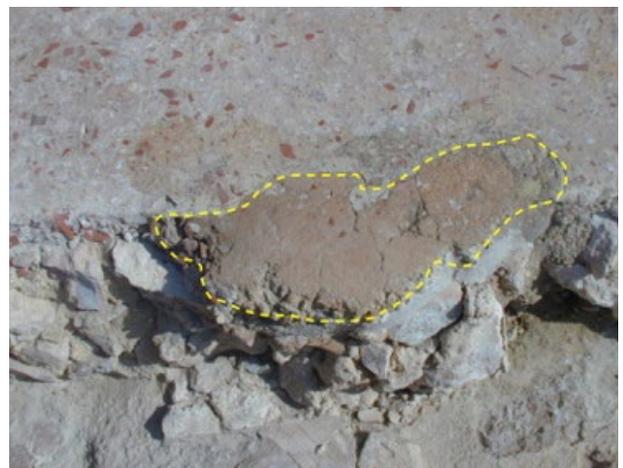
Fragmento del pavimento consolidado. ATM.
